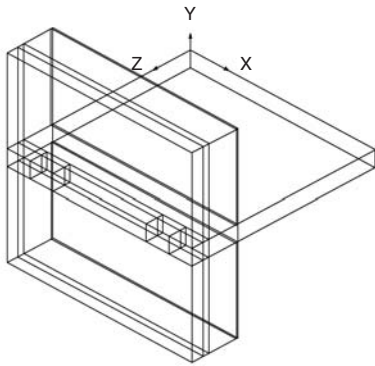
Конечно-элементная модель конструктивного узла сопряжения плиты перекрытия со стеной
